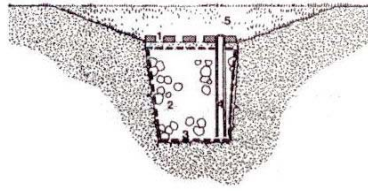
Pozo de infiltración simple alimentado desde la superficie. 1.- Cubierta permeable, 2.- Relleno, 3.- Geotextil, 4.- Piezómetro, 5.- Almacenamiento superficial.
